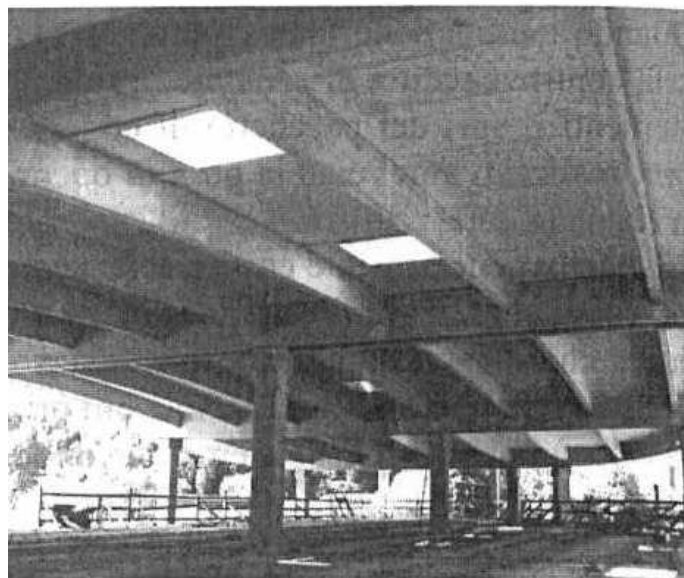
Controventi con pannelli di legno strutturale; vista interna
